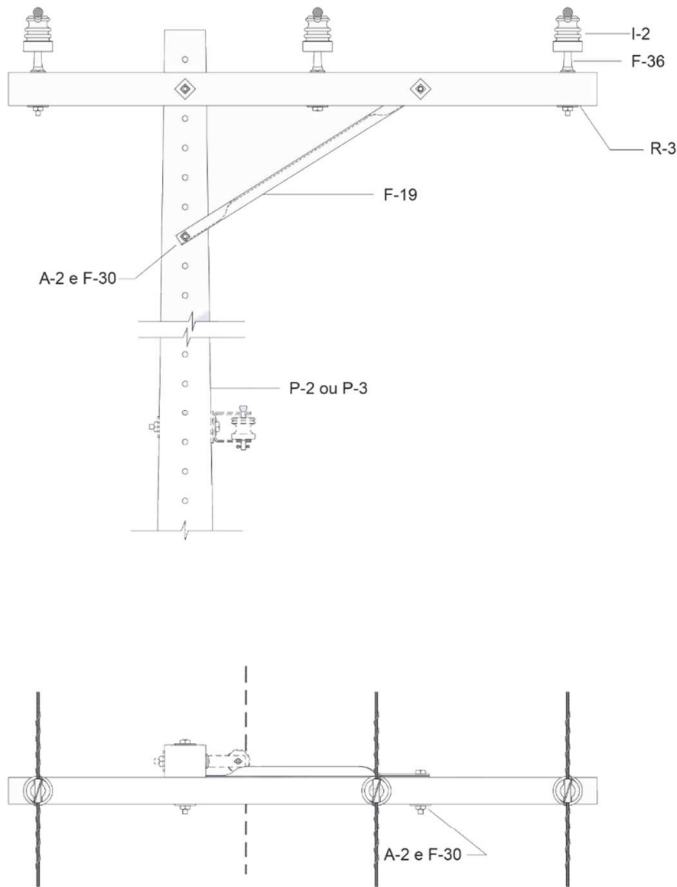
Primário – Estrutura M1 – Poste de concreto de seção circular
